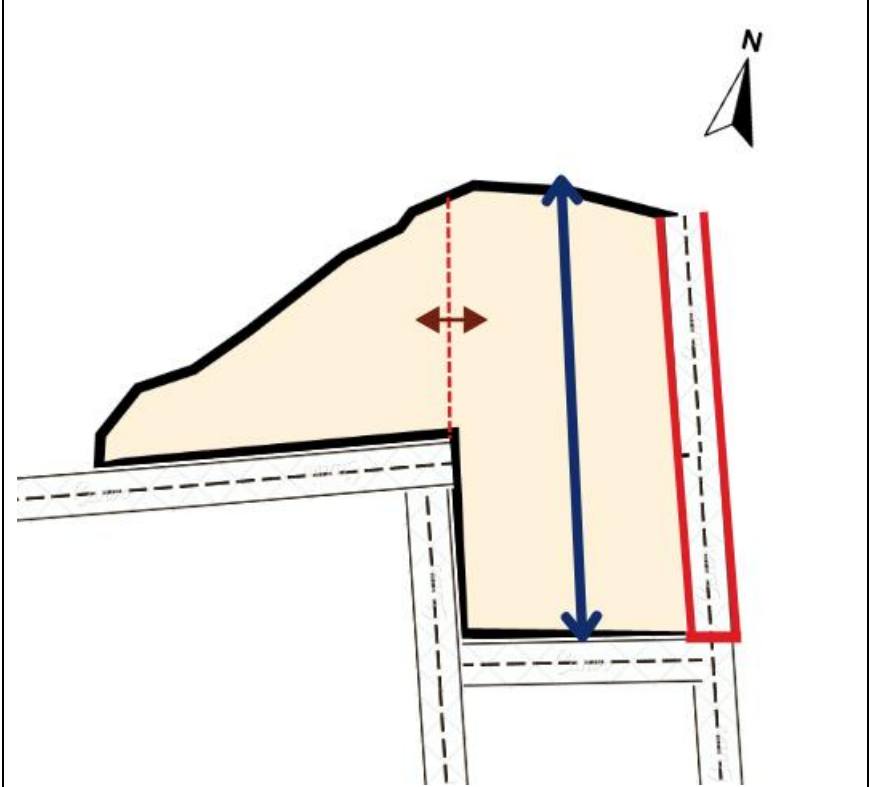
Schéma de plan d'action et les concepts d'aménagement. Source : auteur
